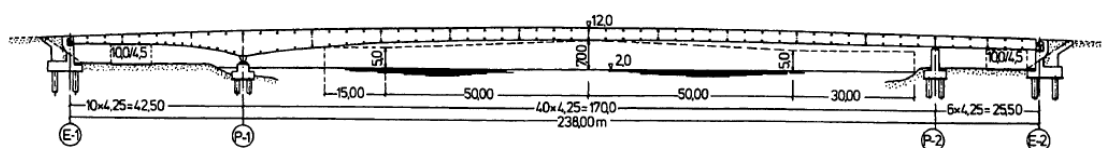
Alçado da ponte La Cartuja, Sevilha (Saul, R. 1998).
